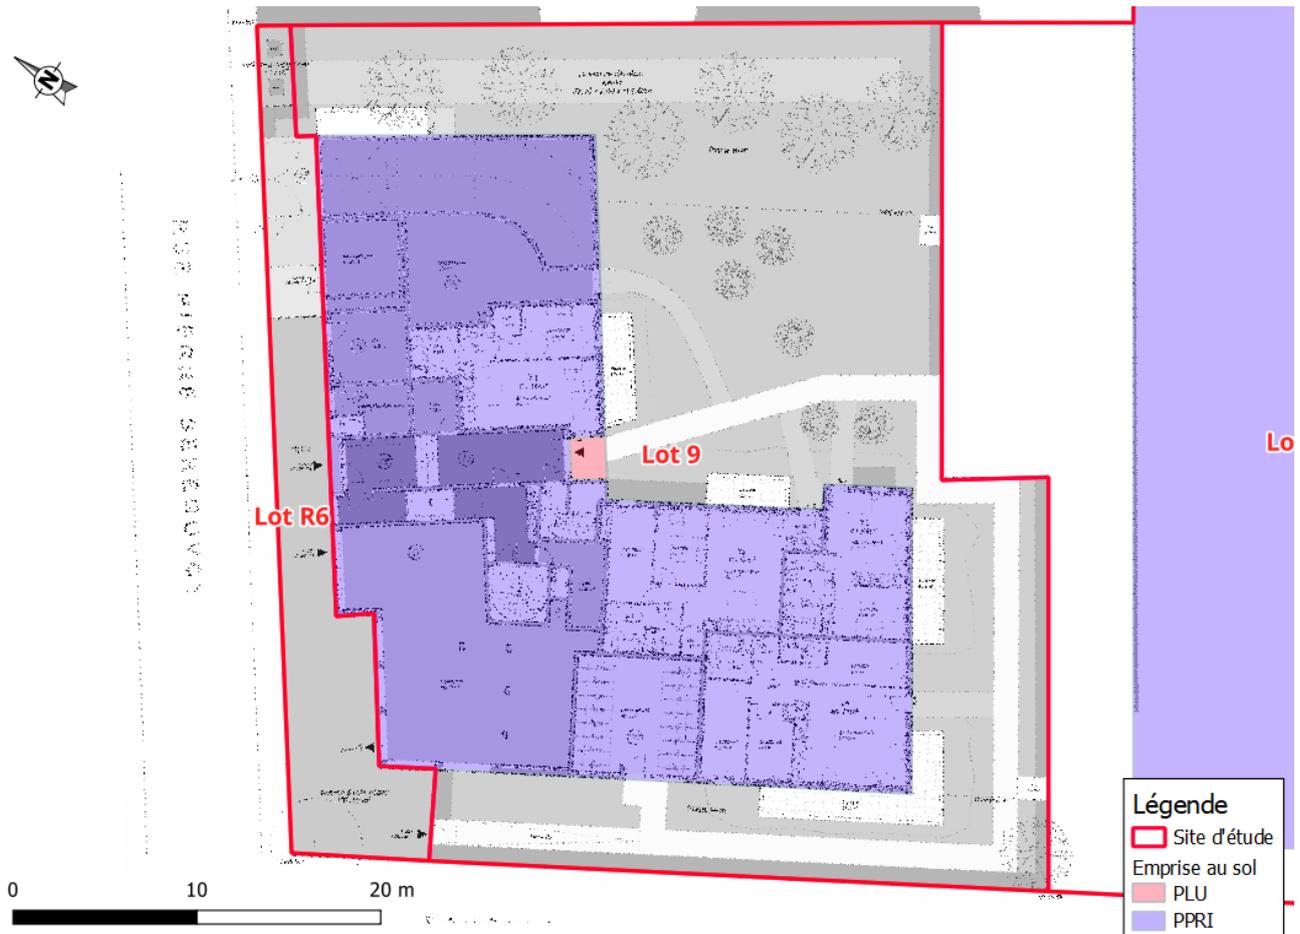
Emprise au sol du Lot 9 (Plan : Rez-de-Chaussée, SNØHETTA Studio Paris, avril 2024)
